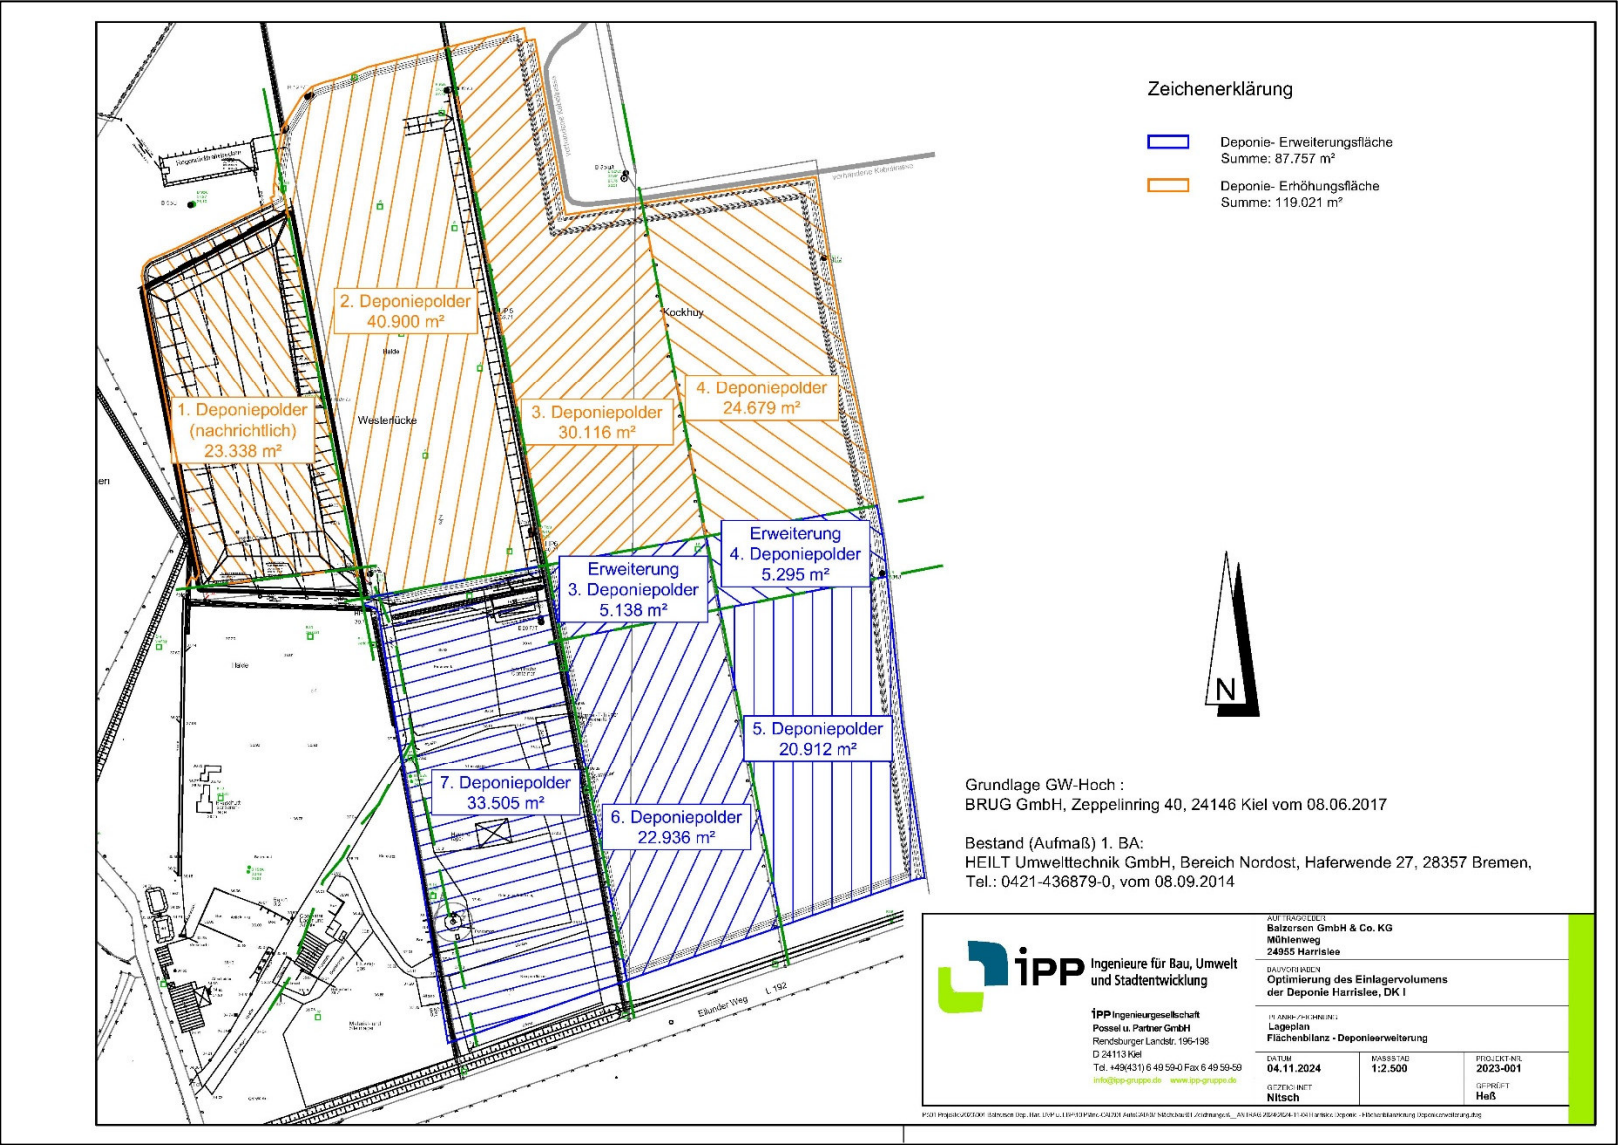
Deponie Harrislee DK 1 am Ellunder Weg, Optimierung des Einlagerungsvolumens Lageplan Flächenbilanz (IPP Stand 04.11.2024)
